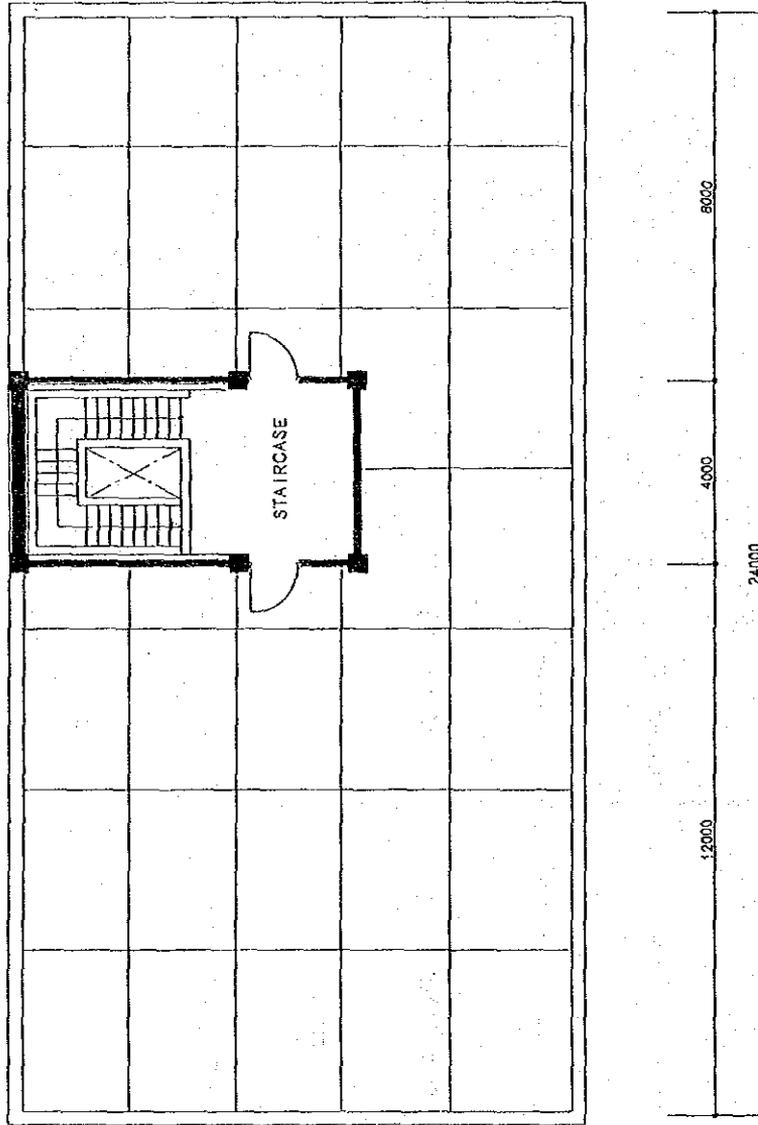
(3) 屋階平面図 (4教室タイプ)
